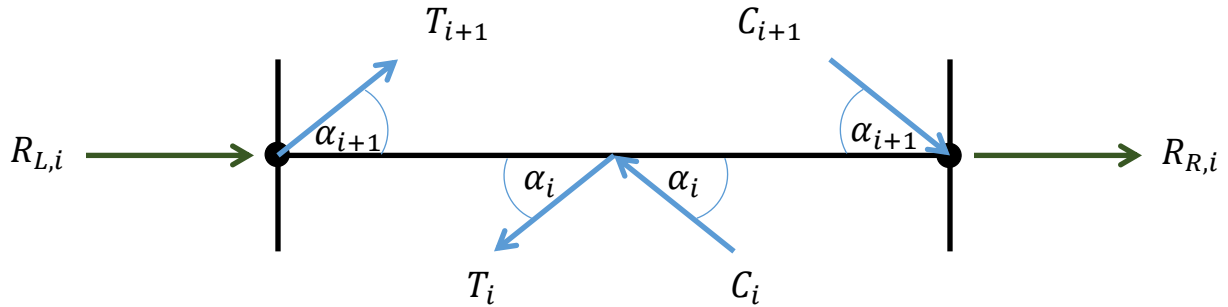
Acción de riostras sobre nodos de conexión viga-columna (Canales, 2016).
